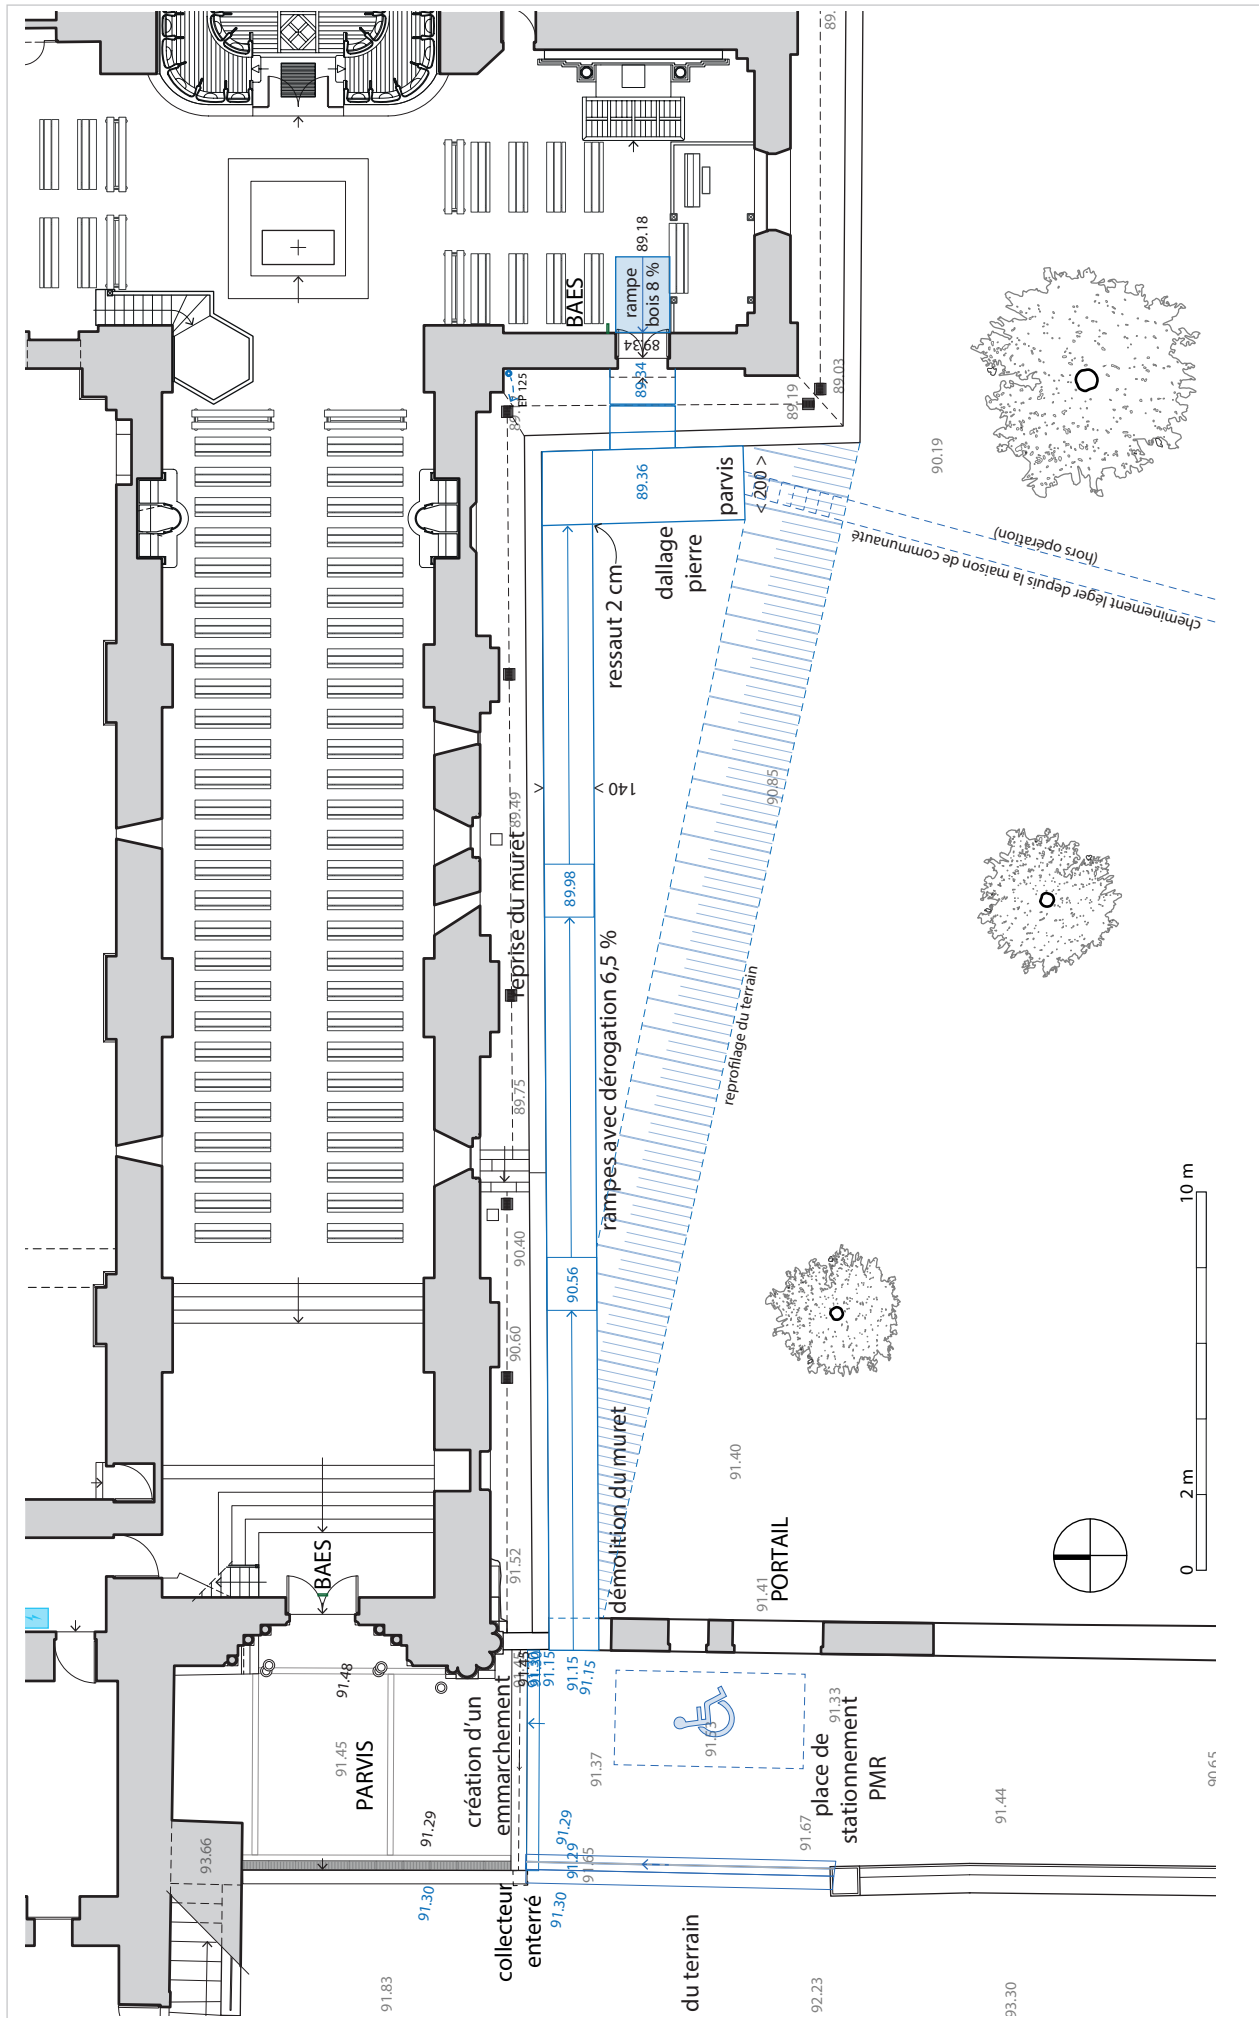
Plan des travaux prévus au niveau du secteur 1 pour la création de la rampe PMR, éch. 1/500'. Source : DODEMAN SARL Architecte
